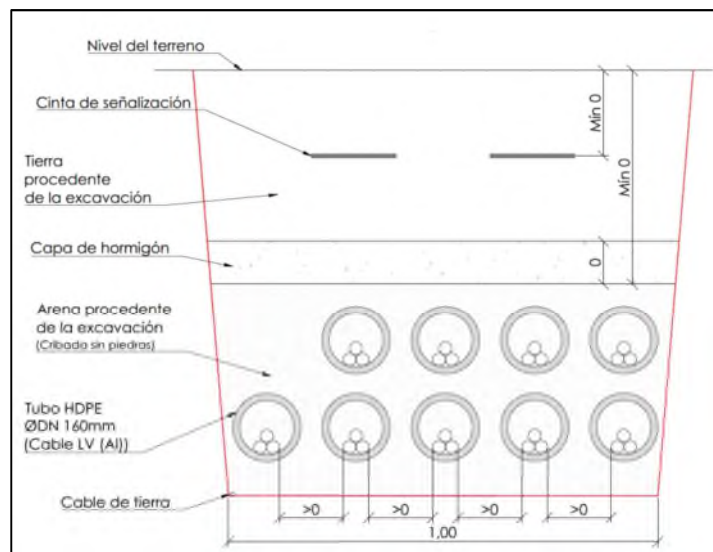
Sección tipo de la zanja para cruces de BT entre las islas 12 y 11 con Vía Pecuaría
